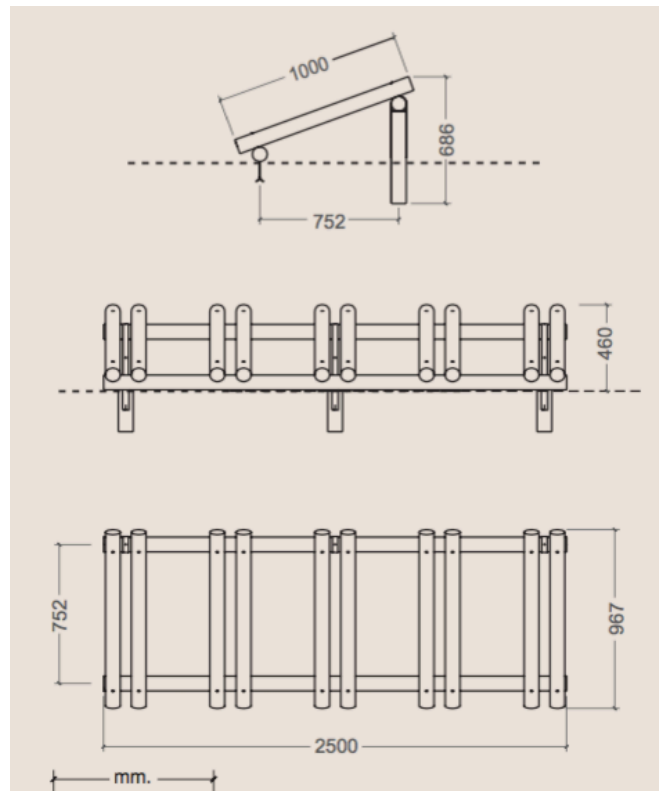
Detalle de perfil, alzado y planta del aparca bicicletas. (Fuente: Mobipark).
